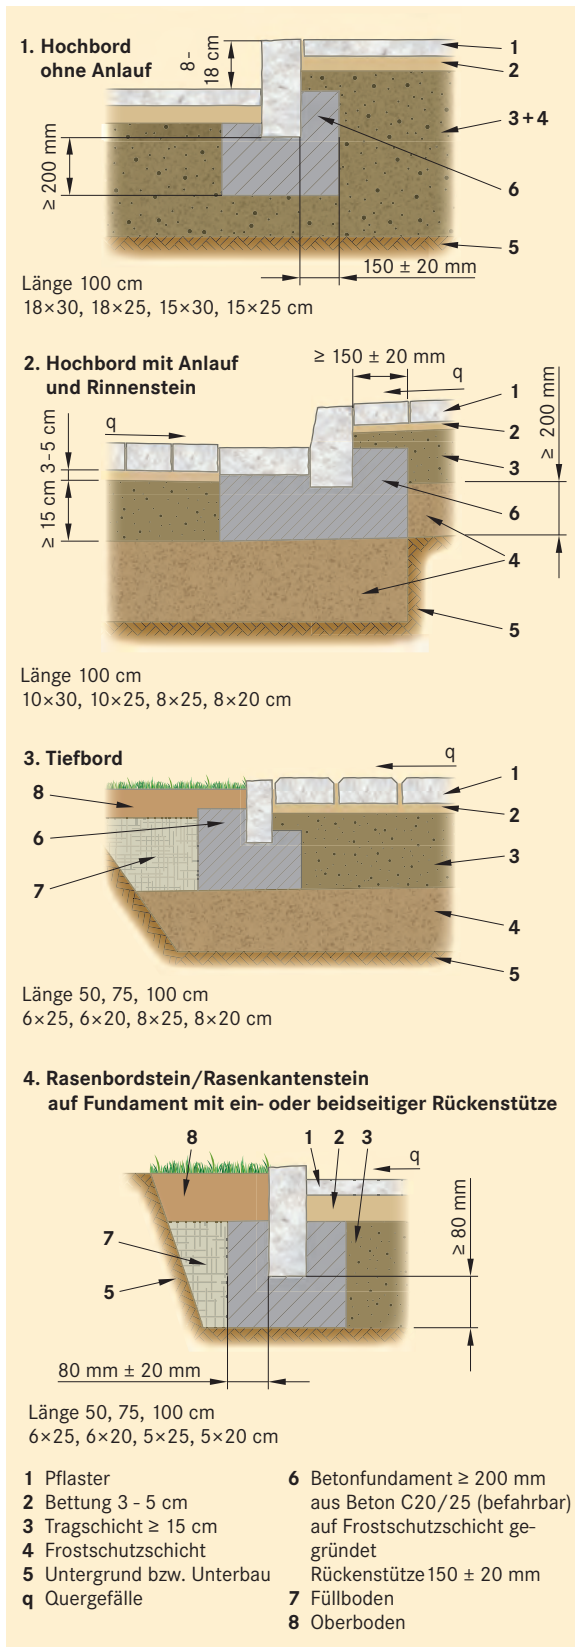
Bordsteine aus Beton, Fertigung nach DIN EN 1340
